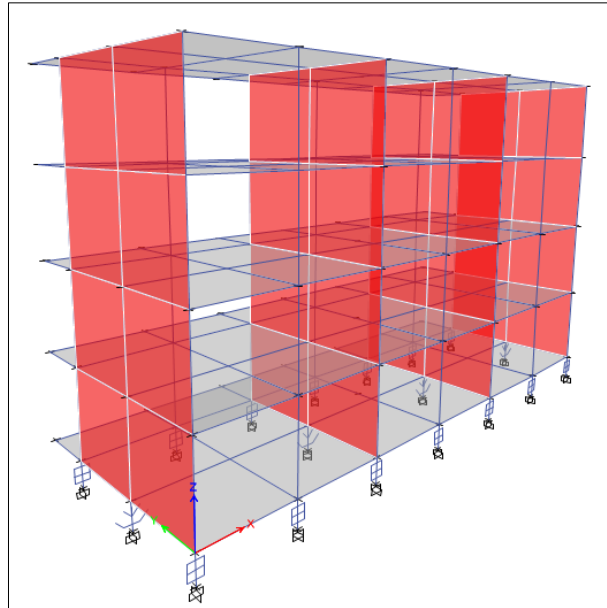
Vista conjunta posterior y lateral del modelo estructural 3D con aislación
